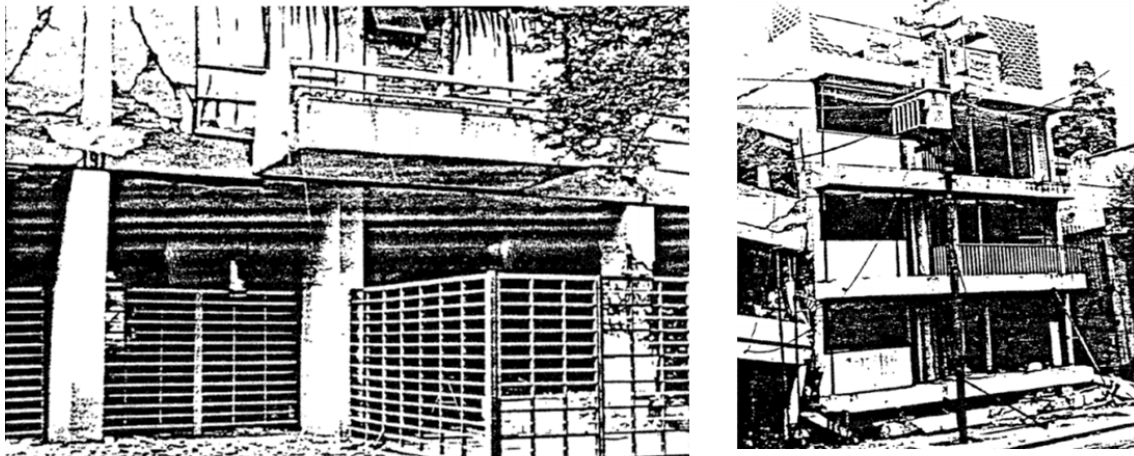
Dos estructuras colapsadas durante el sismo del 19/09/1985 debido a una planta baja débil (Meli et al., 1986)
